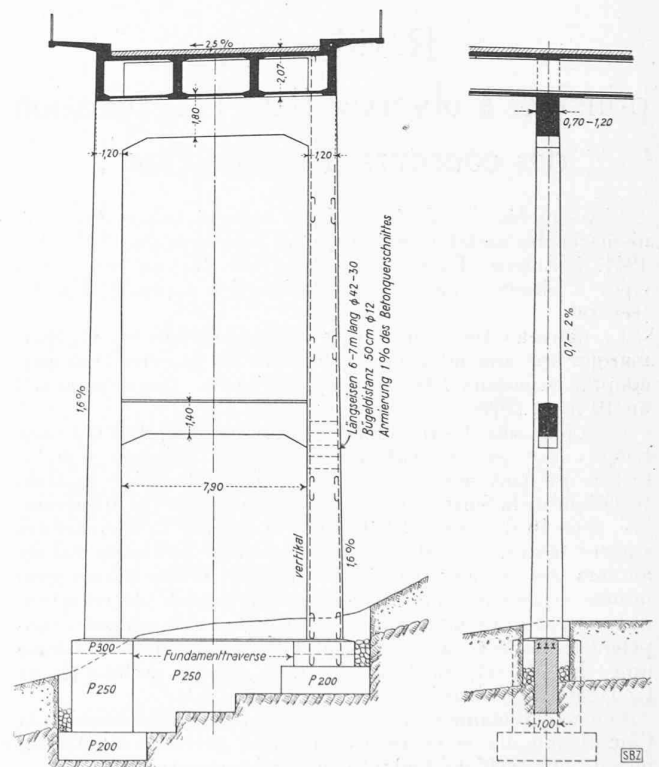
Coupe transversale et longitudinale sur l'un des cadres du viaduc d'accès du pont du Fürstenland.
